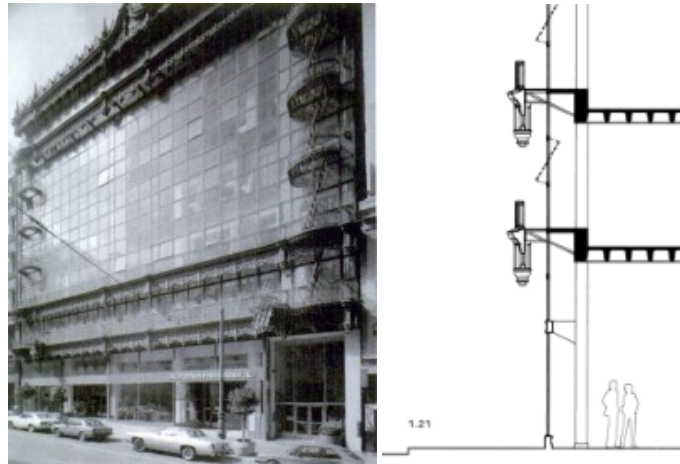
a- Halladie Building, tratto da "Contemporary Curtain Wall Architecture", Murray, 2019; b- Halladie Building dettaglio facciata, tratto da "Contemporary Curtain Wall Architecture", Murray, 2019
